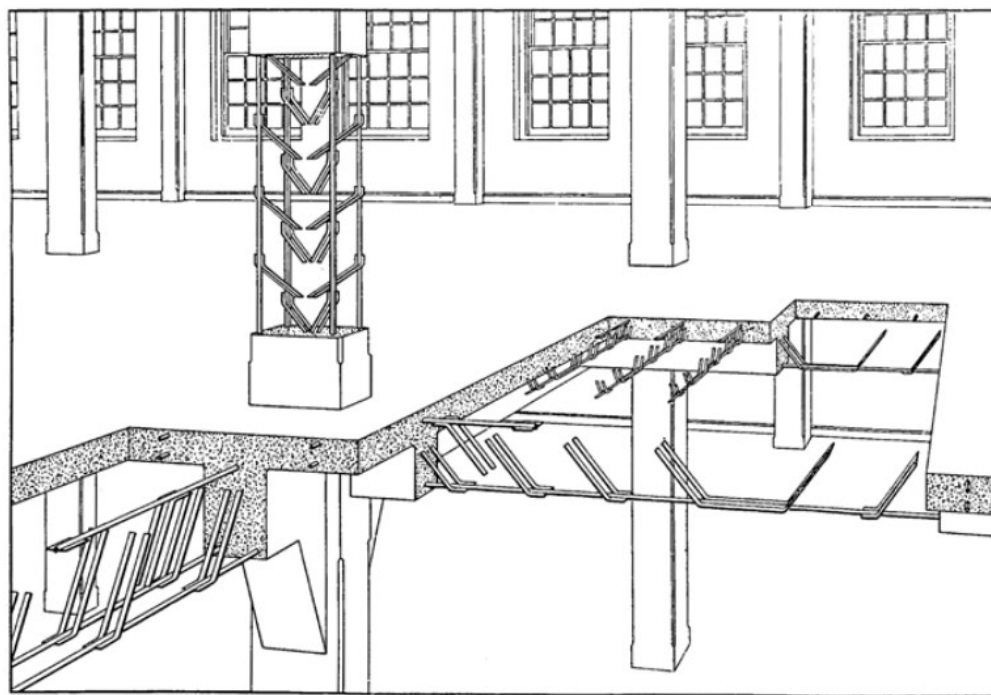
Descripción del Sistema de Kahn para pilares, vigas y forjados. En la revista "Structure Magazine" de abril de 2013
